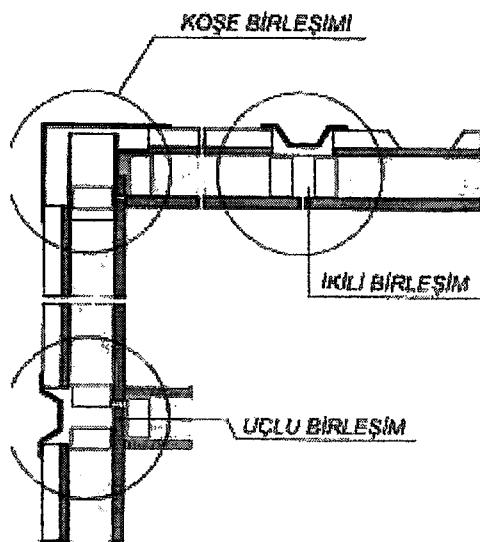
Konteynerlerin sistem detayı (Prefabrik Yapı, s.63)
